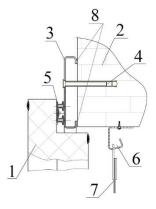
Узел 2 (сечение Б-Б). Крепление металлической накладной рамы к стене из бетона или кирпича.
